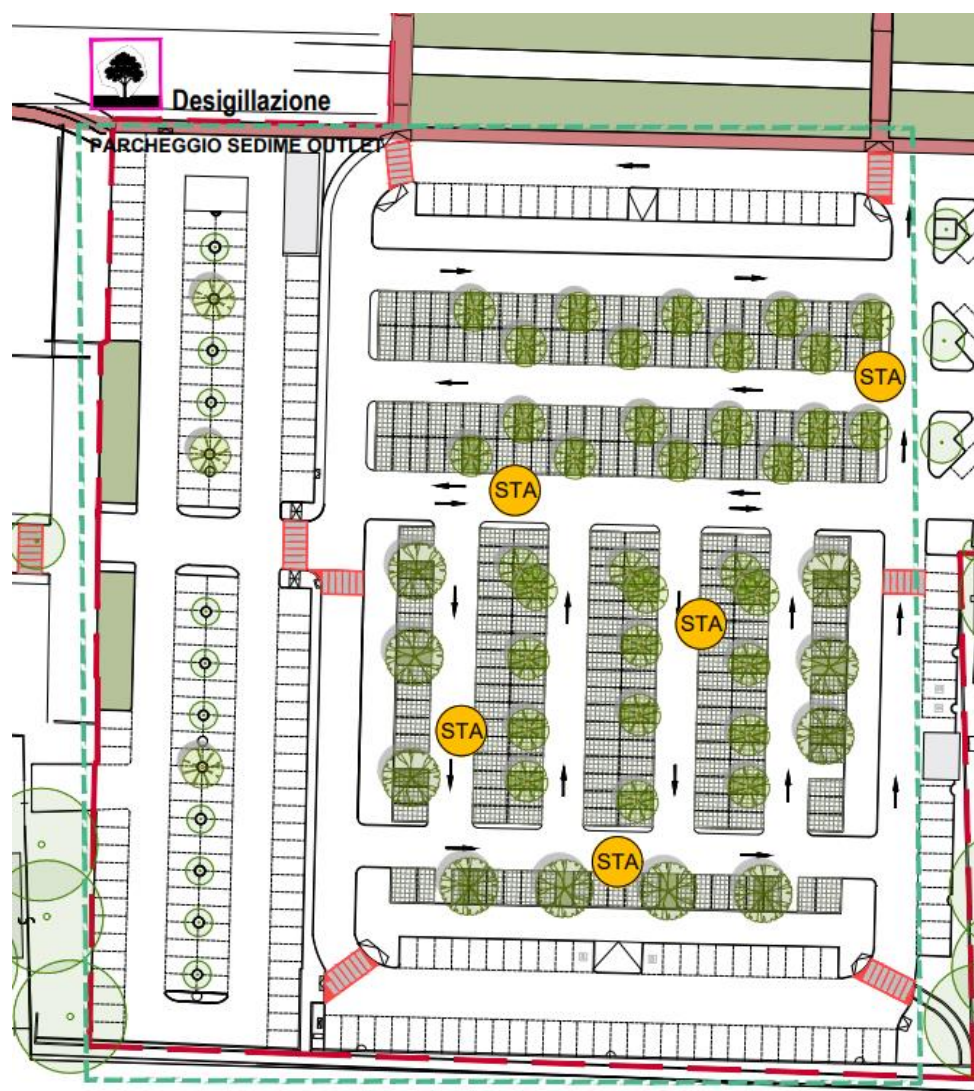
Progetto dei parcheggi dell'area dell'ex Outlet
